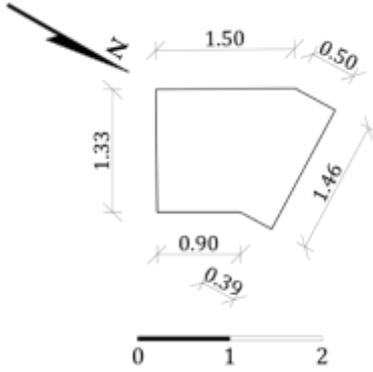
مسقط أفقي للمنور بدهليز
